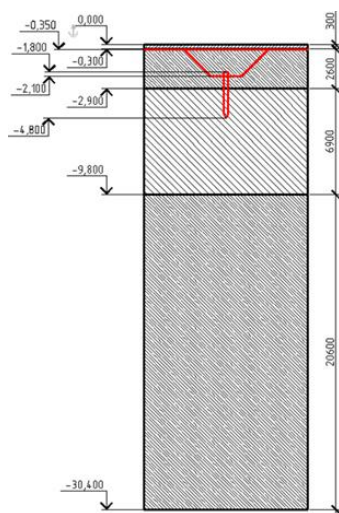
Розташування пальового фундаменту в ґрунті
